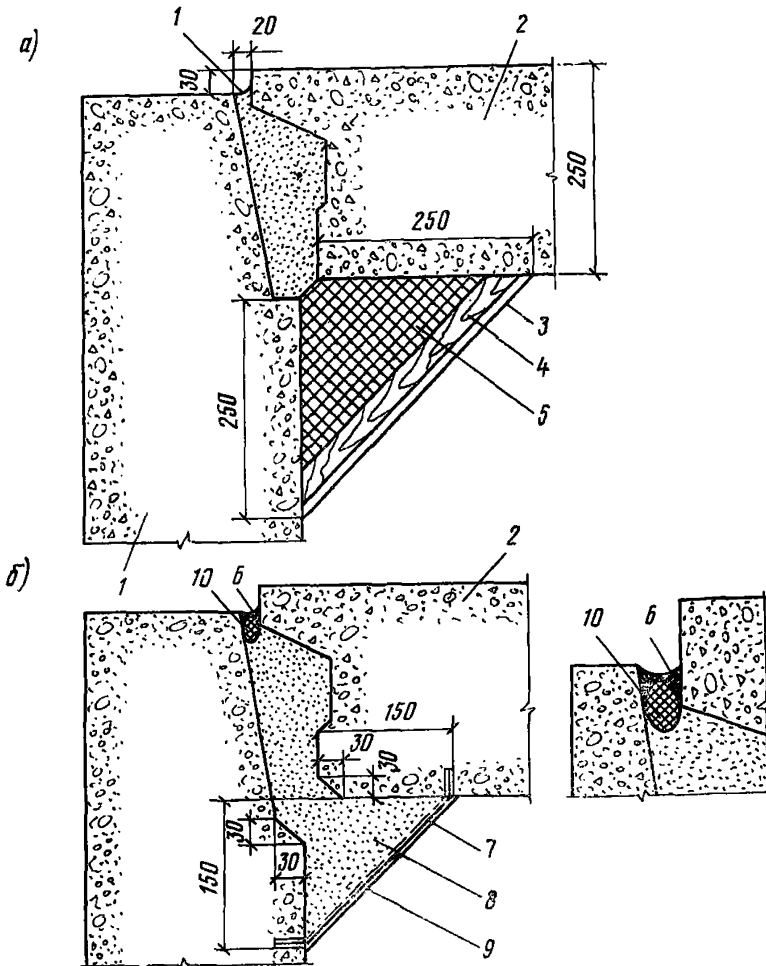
Утепление вертикального стыка наружных стеновых керамзитобетонных панелей в углах здания
